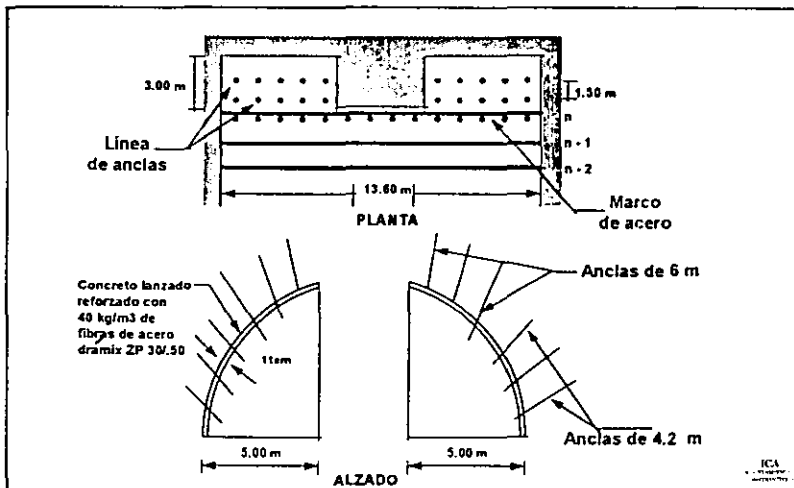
Excavación hasta 3.0 m. en los túneles laterales y anclaje de la sección.
